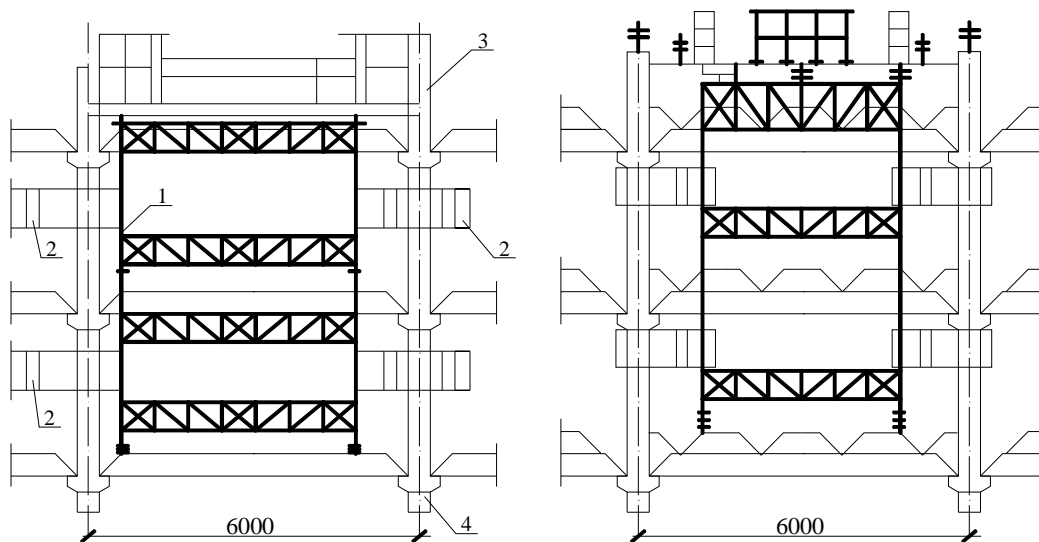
Типи монтажного обладнання для монтажу колони на під-колонники:
